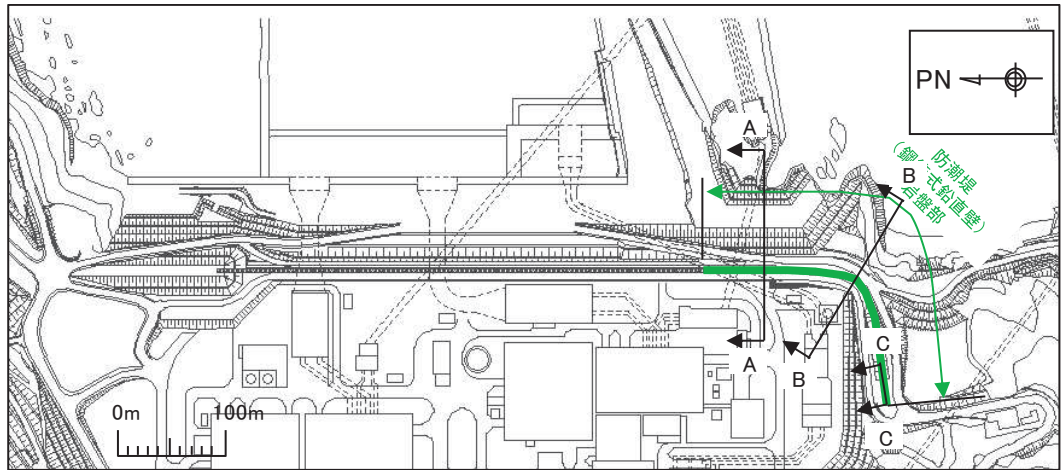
鋼管式鉛直壁（岩盤部）平面配置図
